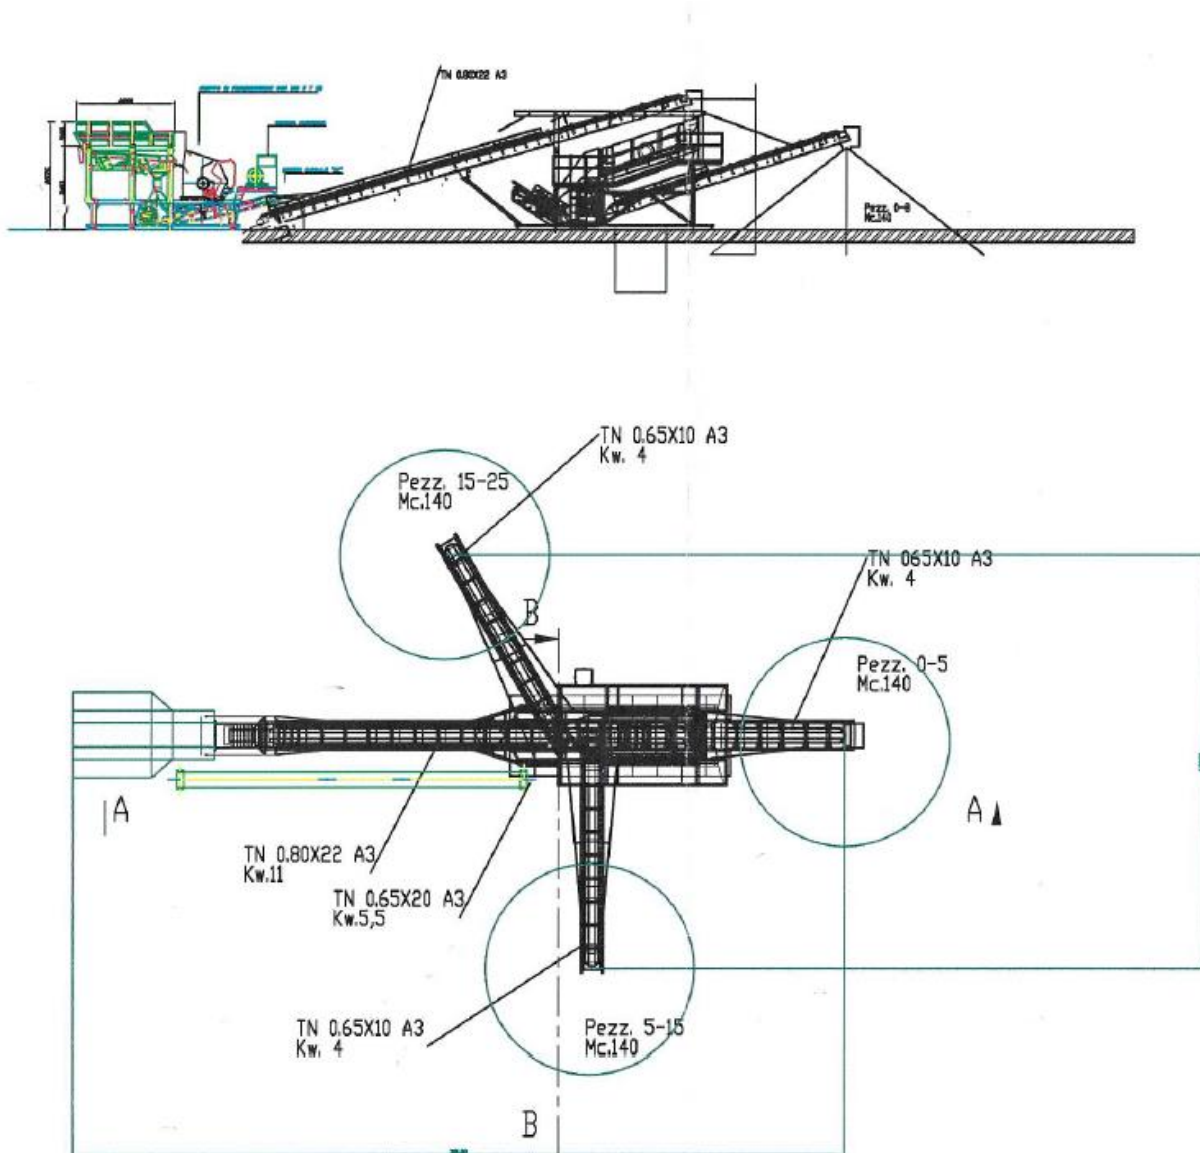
Layout schematico dell'impianto di frantumazione e vagliatura inerti
